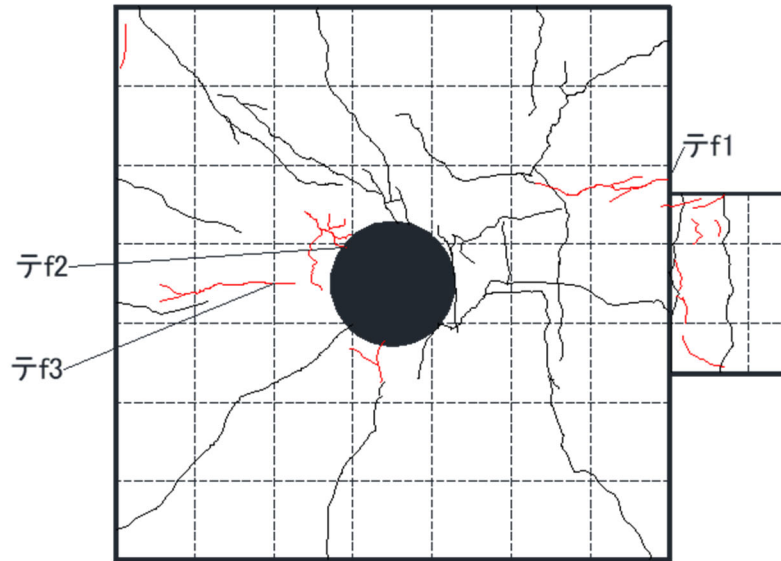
2. 3-82 パイルキャップ底面ひび割れ幅測定位置 (試験体 DR-2 -7.0 サイクル)
